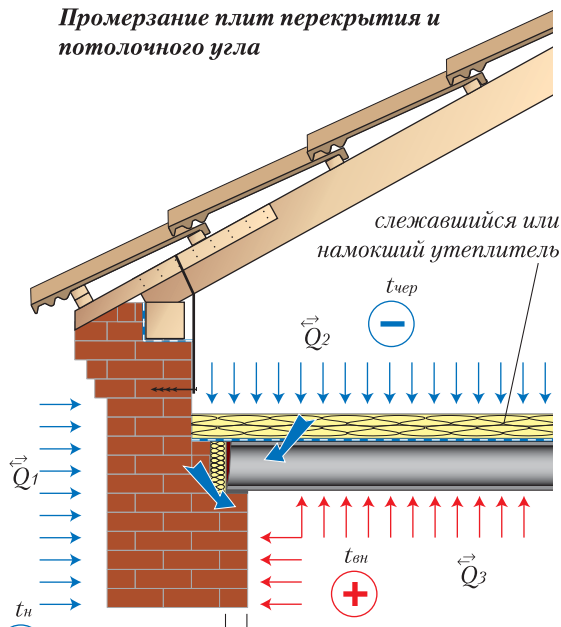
Промерзание перекрытия из-за неправильного опирания плит перекрытия
